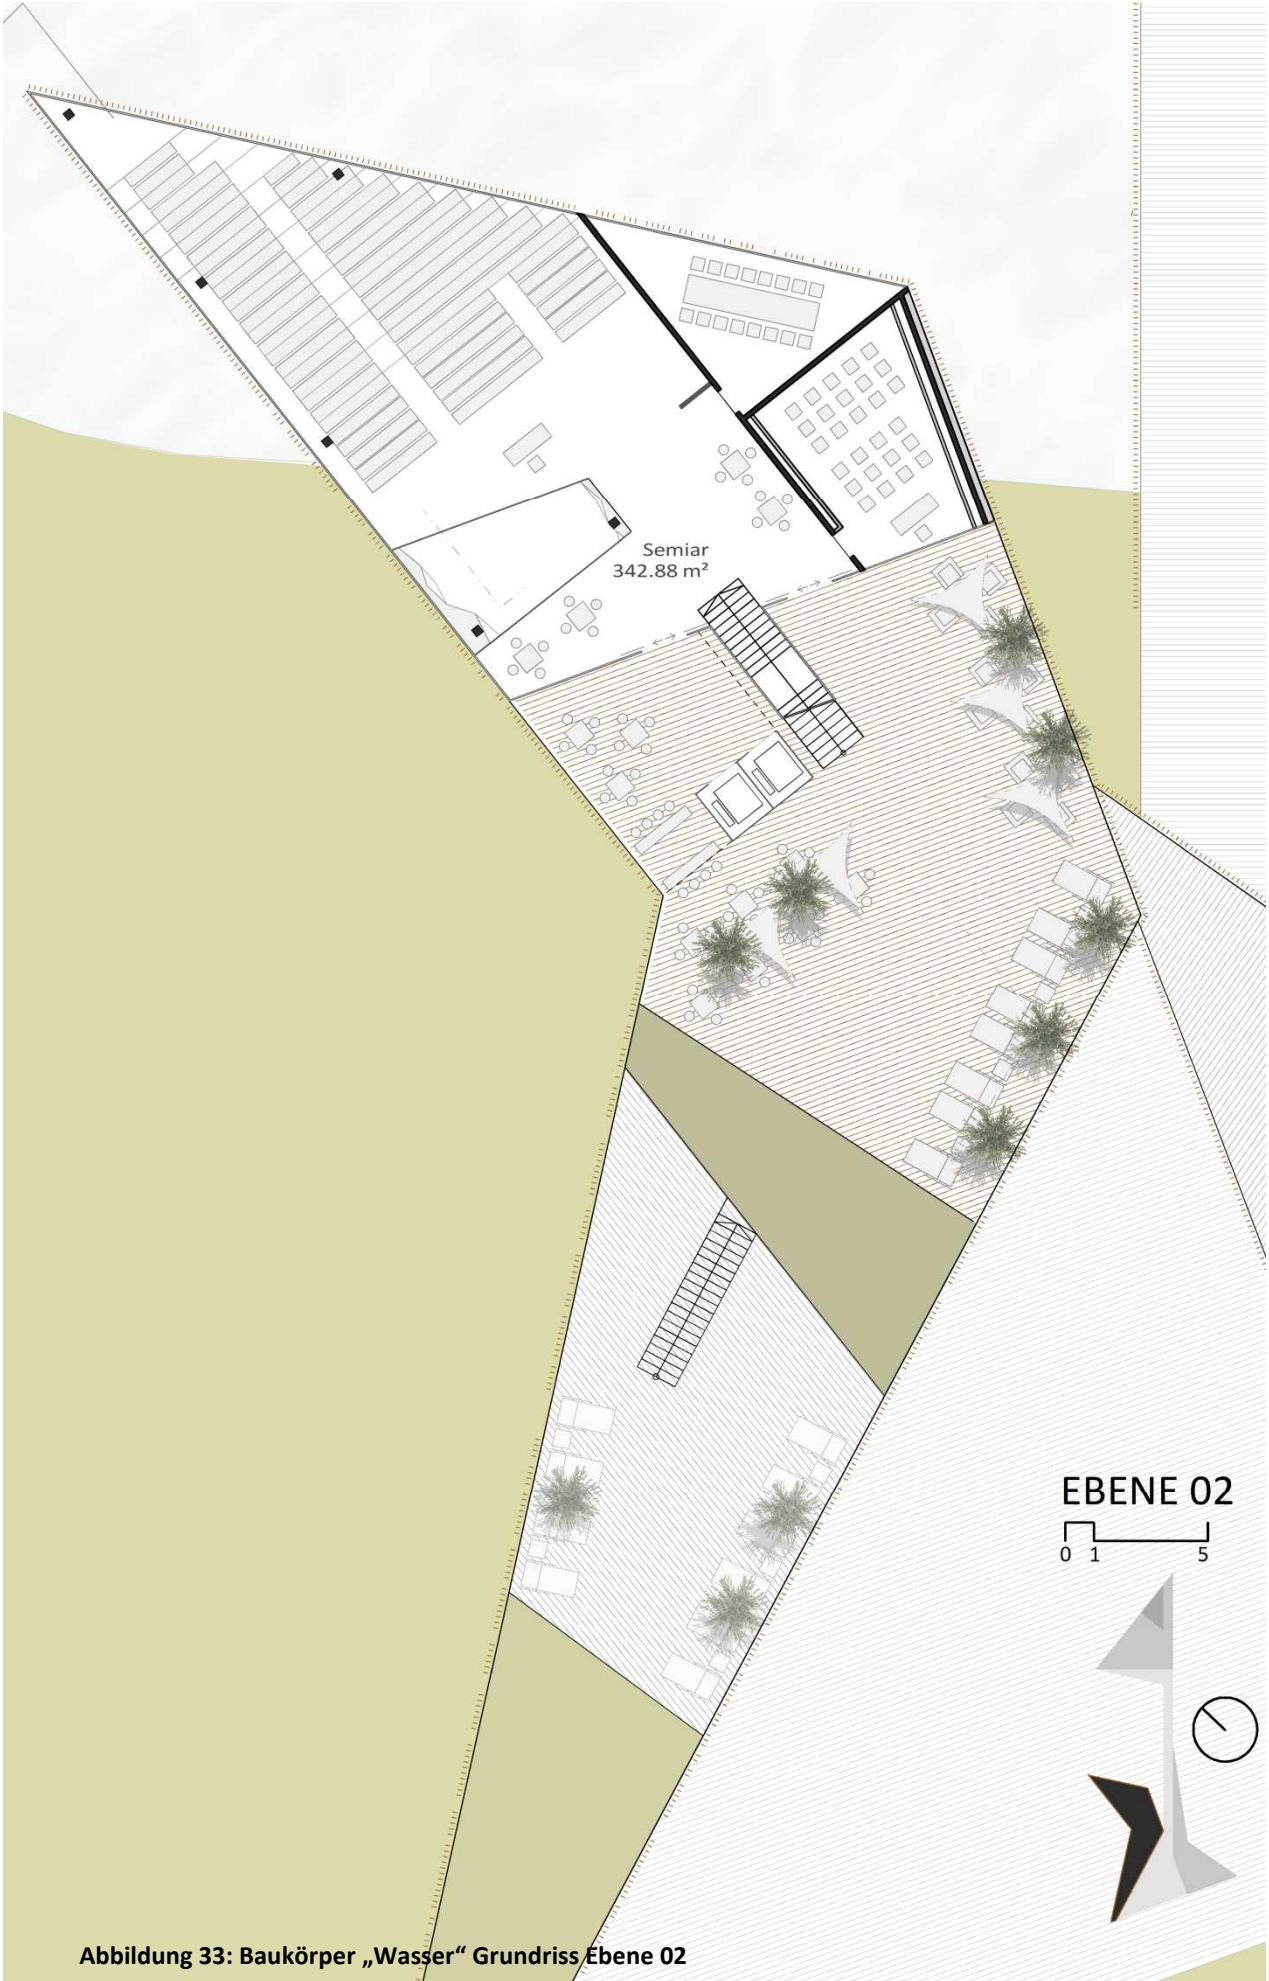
Baukörper „Wasser“ Grundriss Ebene 02
